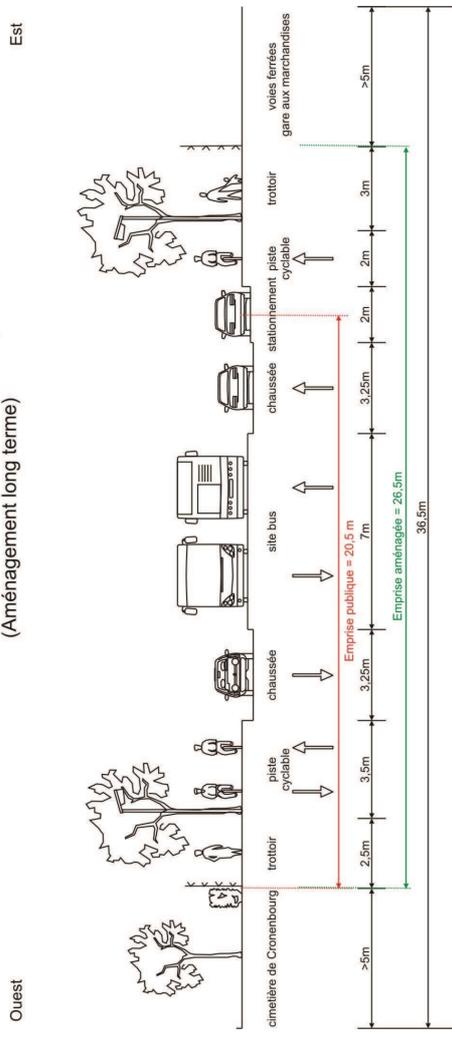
Situation projetée (coupe 20) route de Hochfelden (aménagement à long terme)
